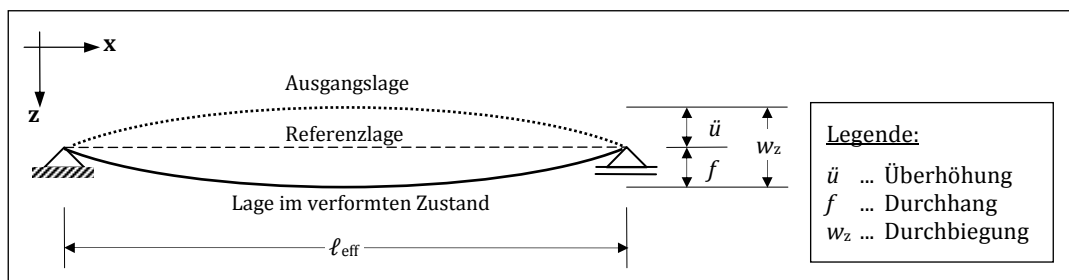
Definitionen zur Beschreibung der Biegeverformung im Stahlbetonbau
